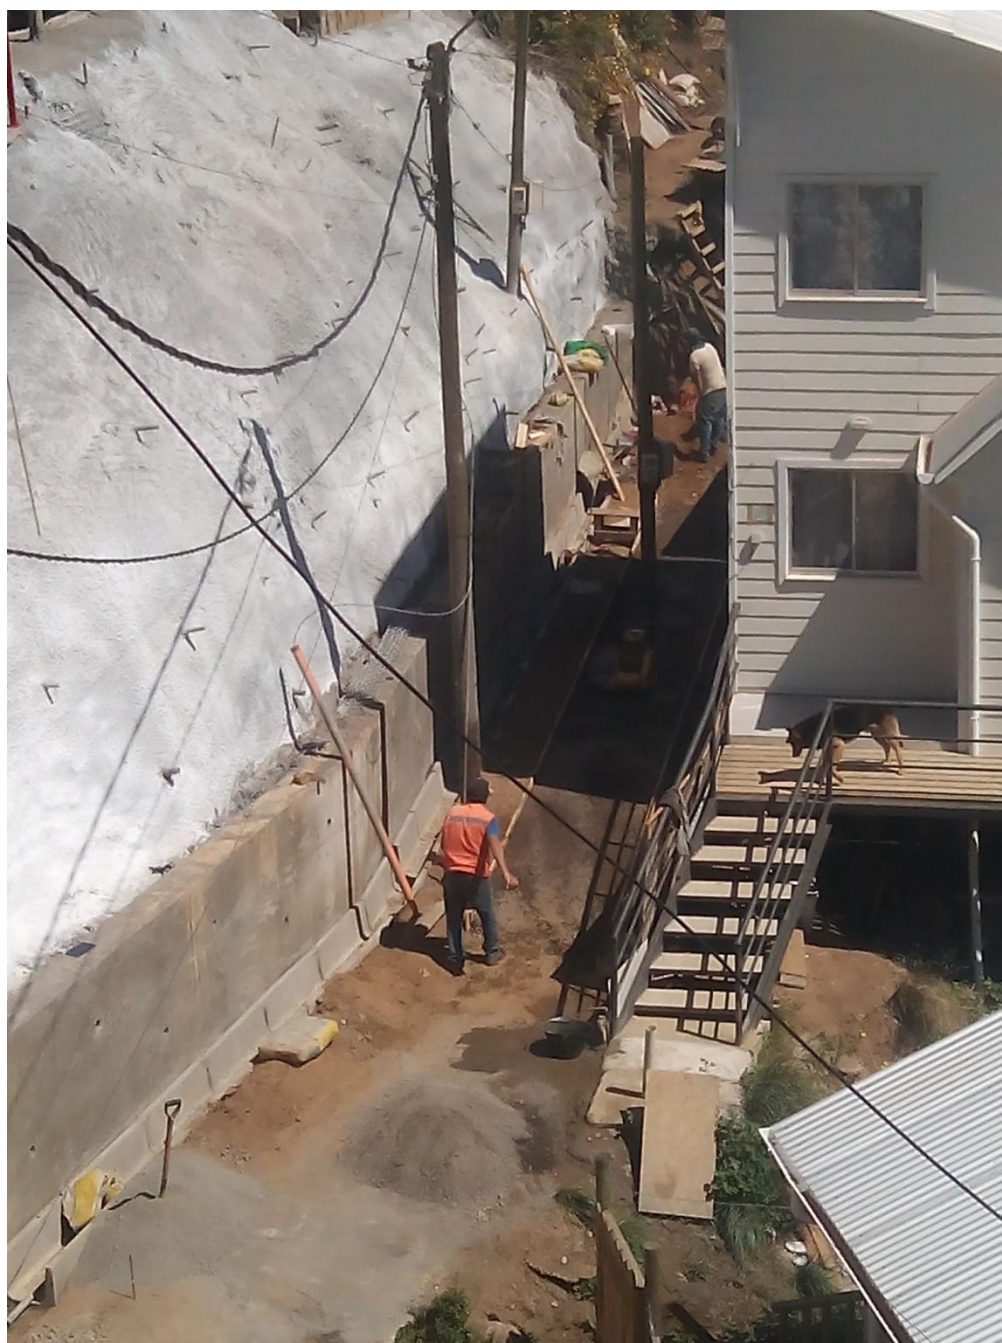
Vista general preparación de la base estabilizada Acera proyectada,
